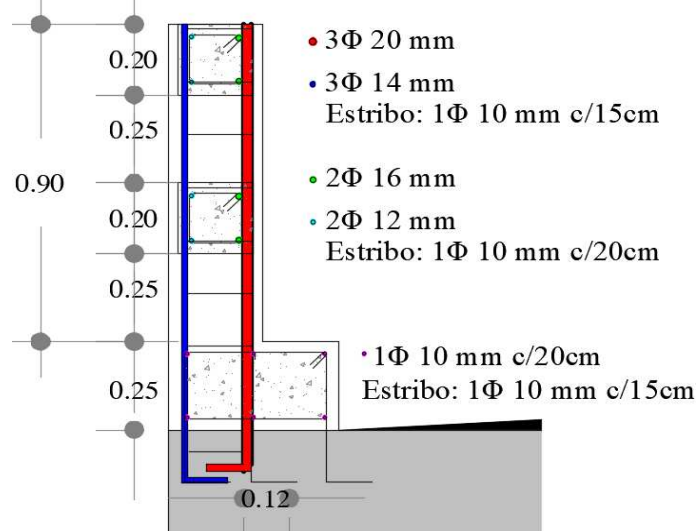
Diseño final de la protección lateral de hormigón armado (poste - viga)
